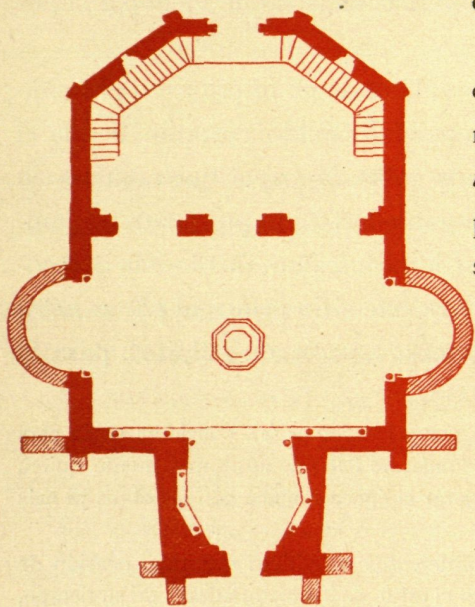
PLANTA DEL BAPTISTERIO DE SAN JUAN EN POITIERS
